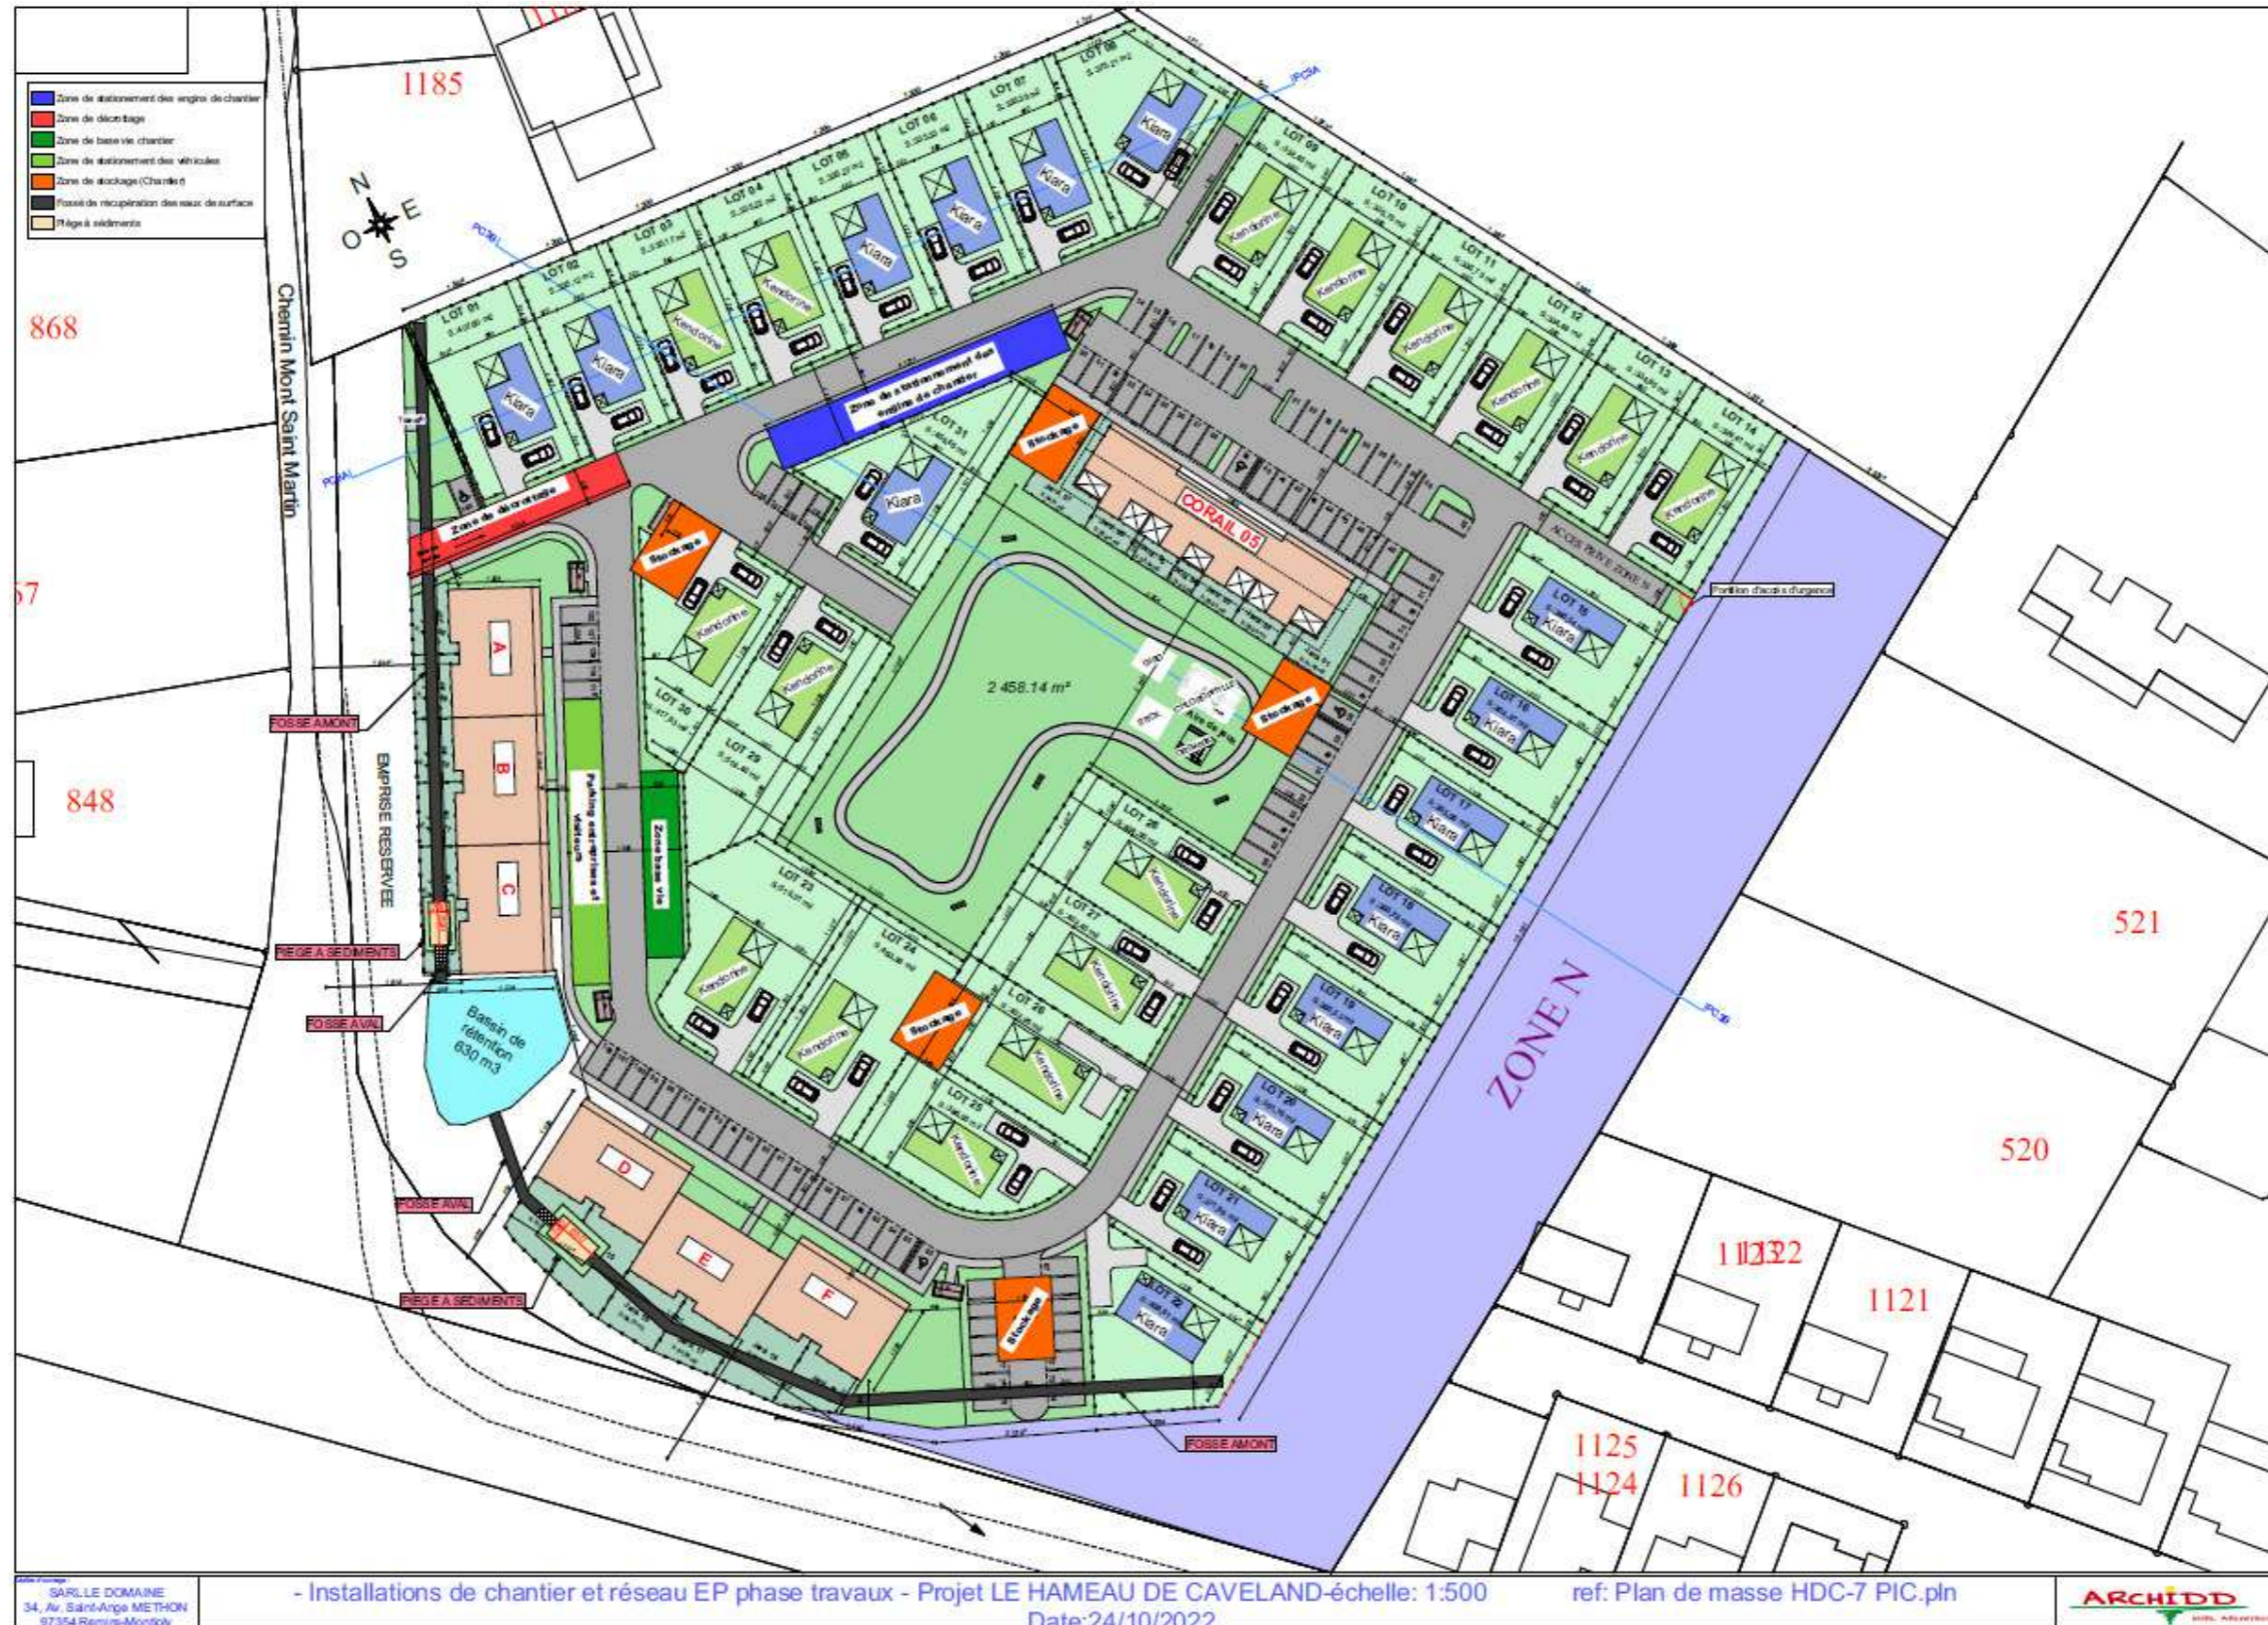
Plan des installations de chantier et du réseau EP en phase chantier
